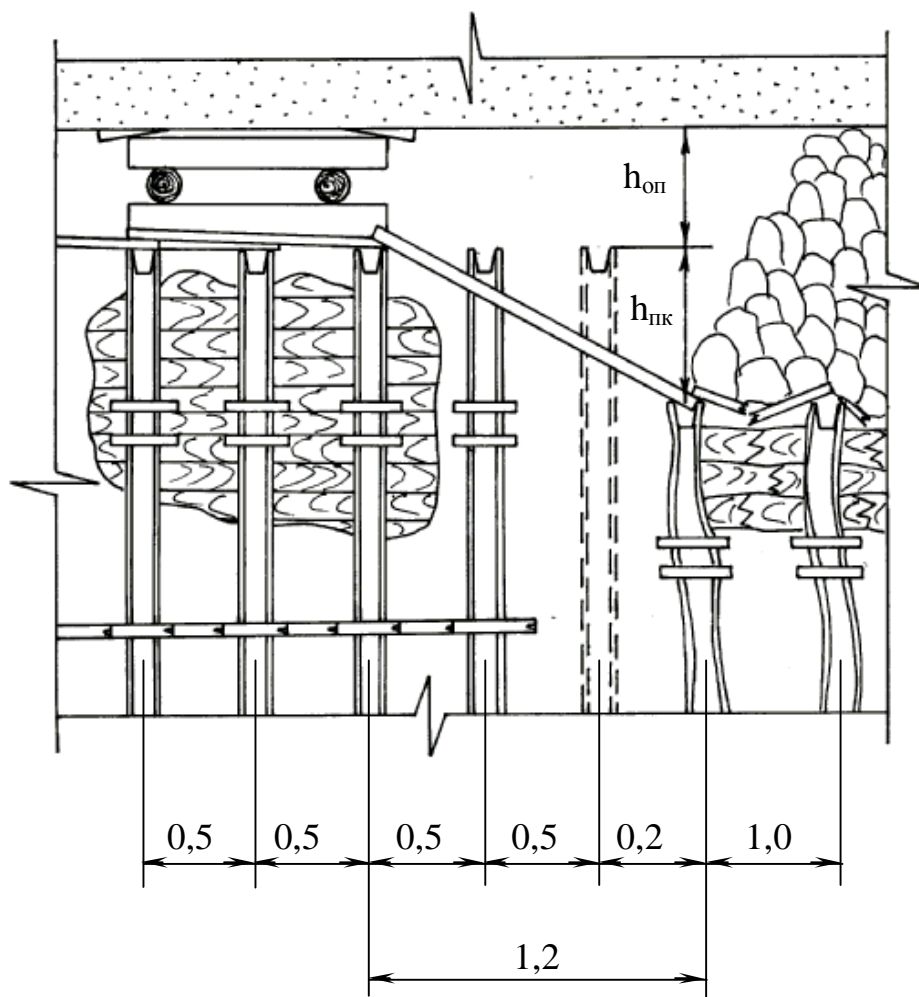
Схема установки временного деревянного перекрытия с опорой на верхняки (размеры в м)
